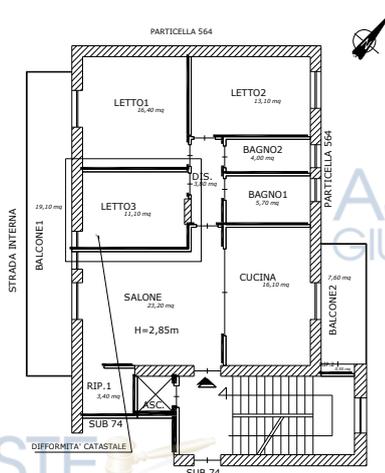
planimetria delle difformità catastali dell'appartamento al quarto piano
